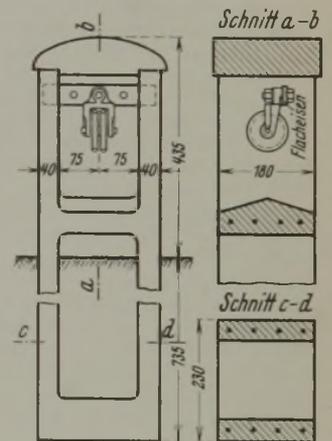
Betonständer für 1 bis 2 Leitungen. (Bauart Roudolf.)
